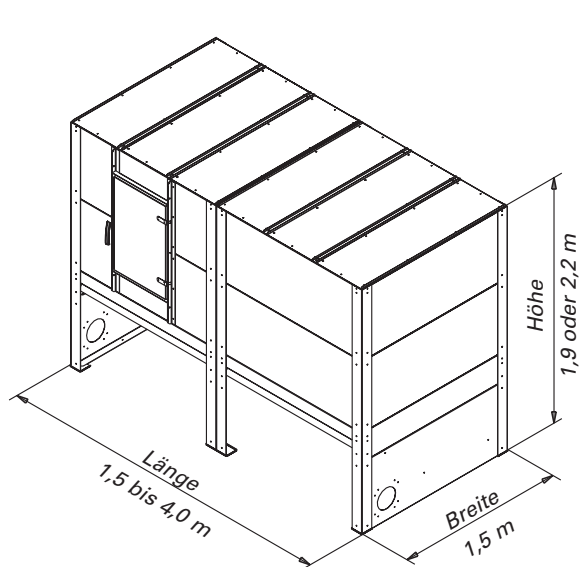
Stahlblech-Tanks mit Breite 1,5 m
